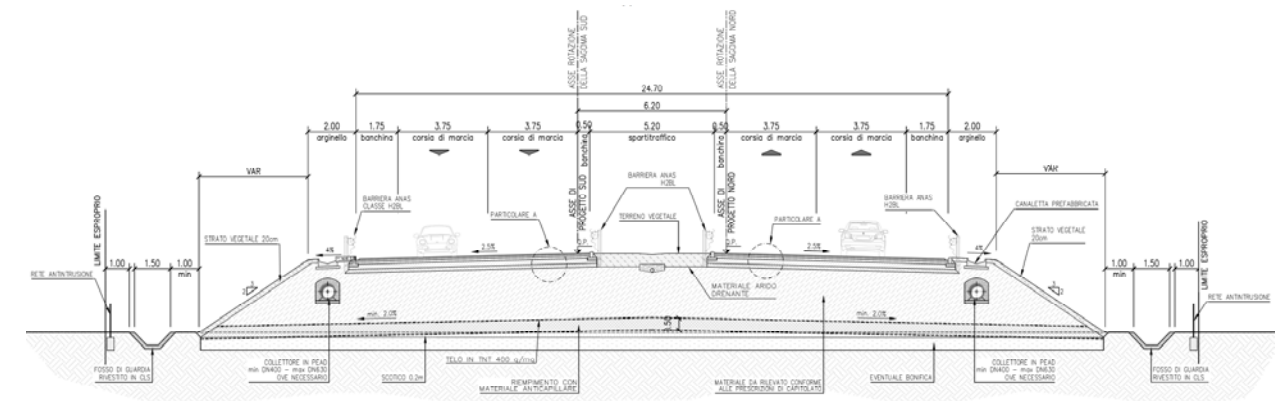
Asse principale - Sezione tipo in rilevato
